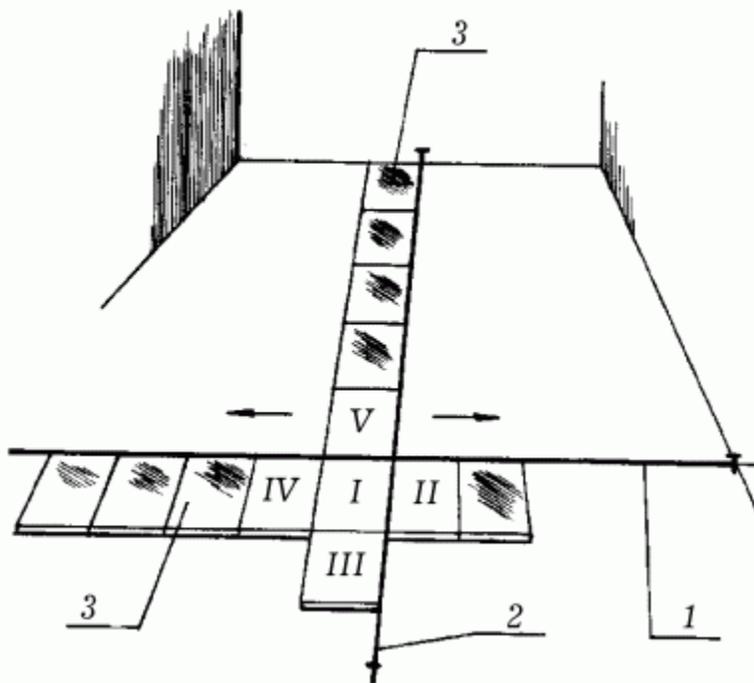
Разбивка помещения под укладку плиток ПВХ: 1 – причальный шнур, натянутый по продольной оси помещения; 2 –
